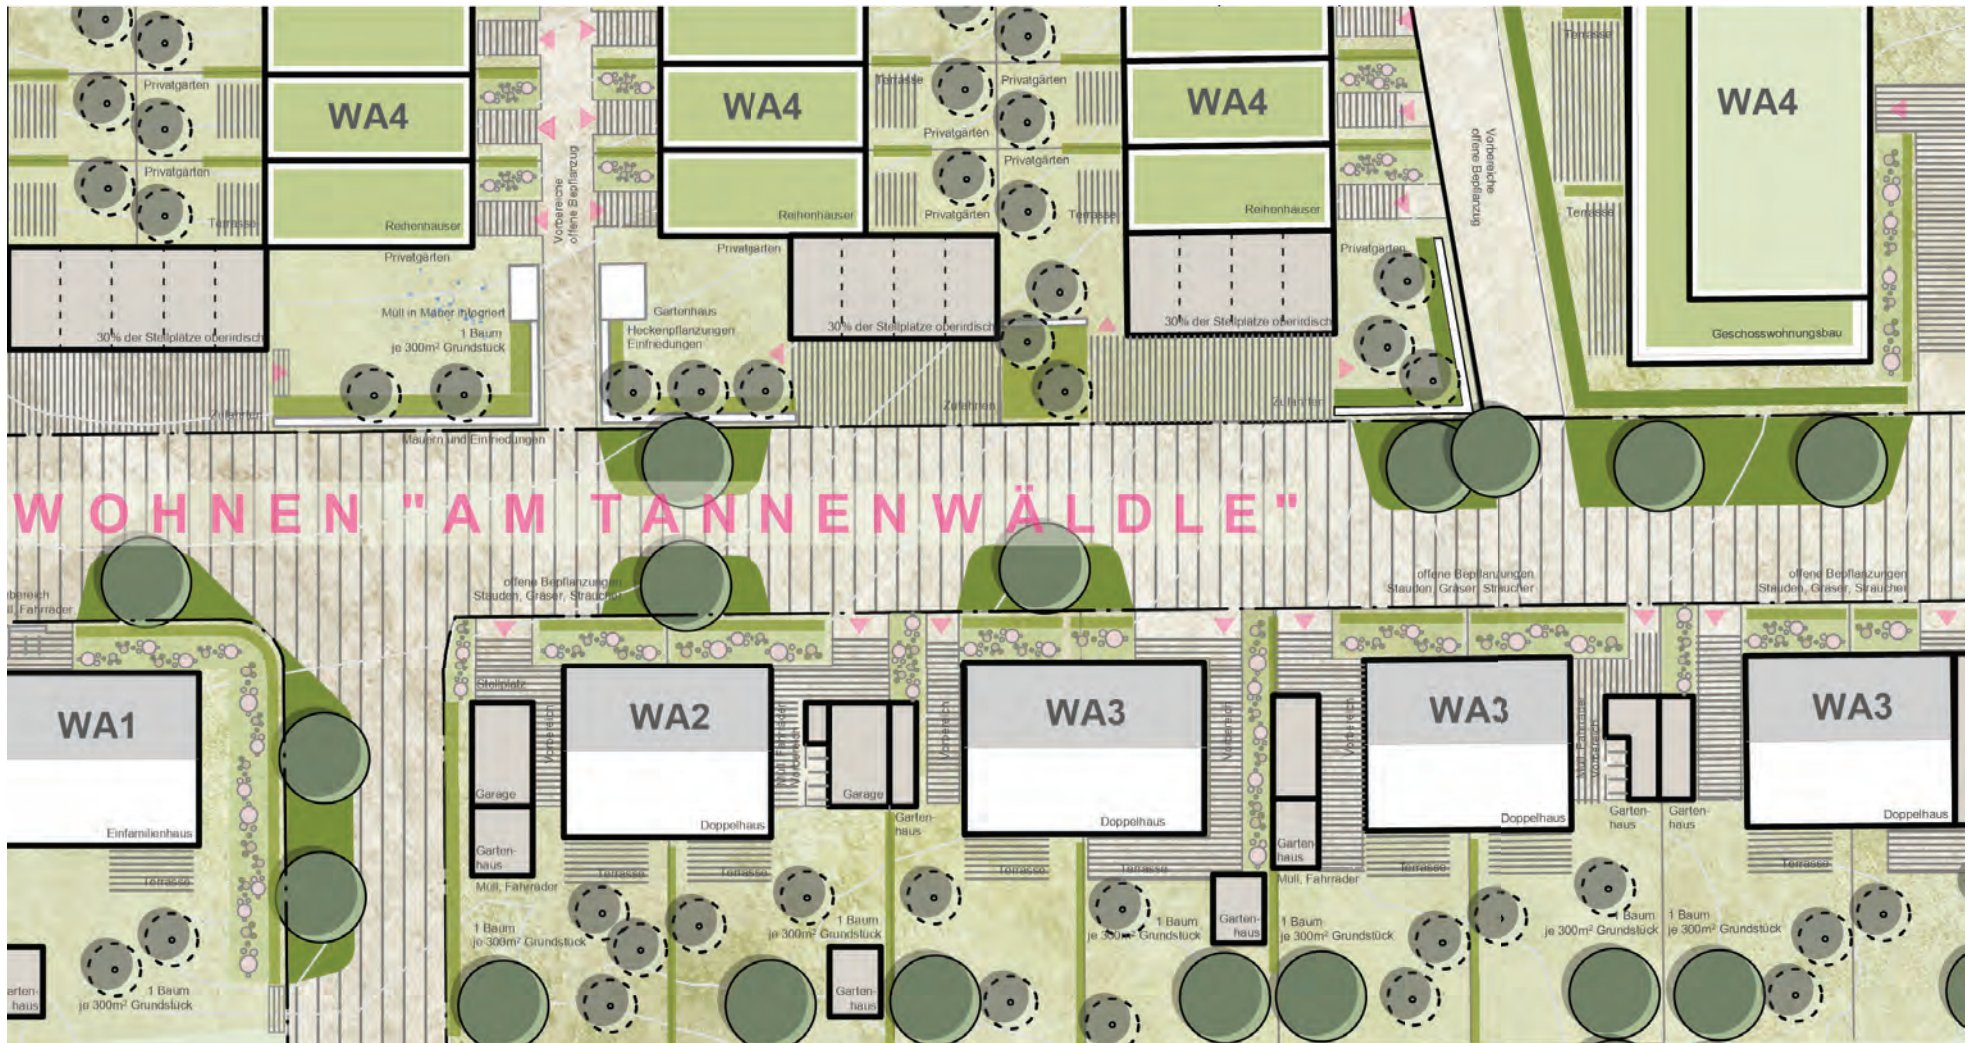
Prinzipdarstellung Gestaltung Vorgärten, Privatgärten und Nebenanlagen
